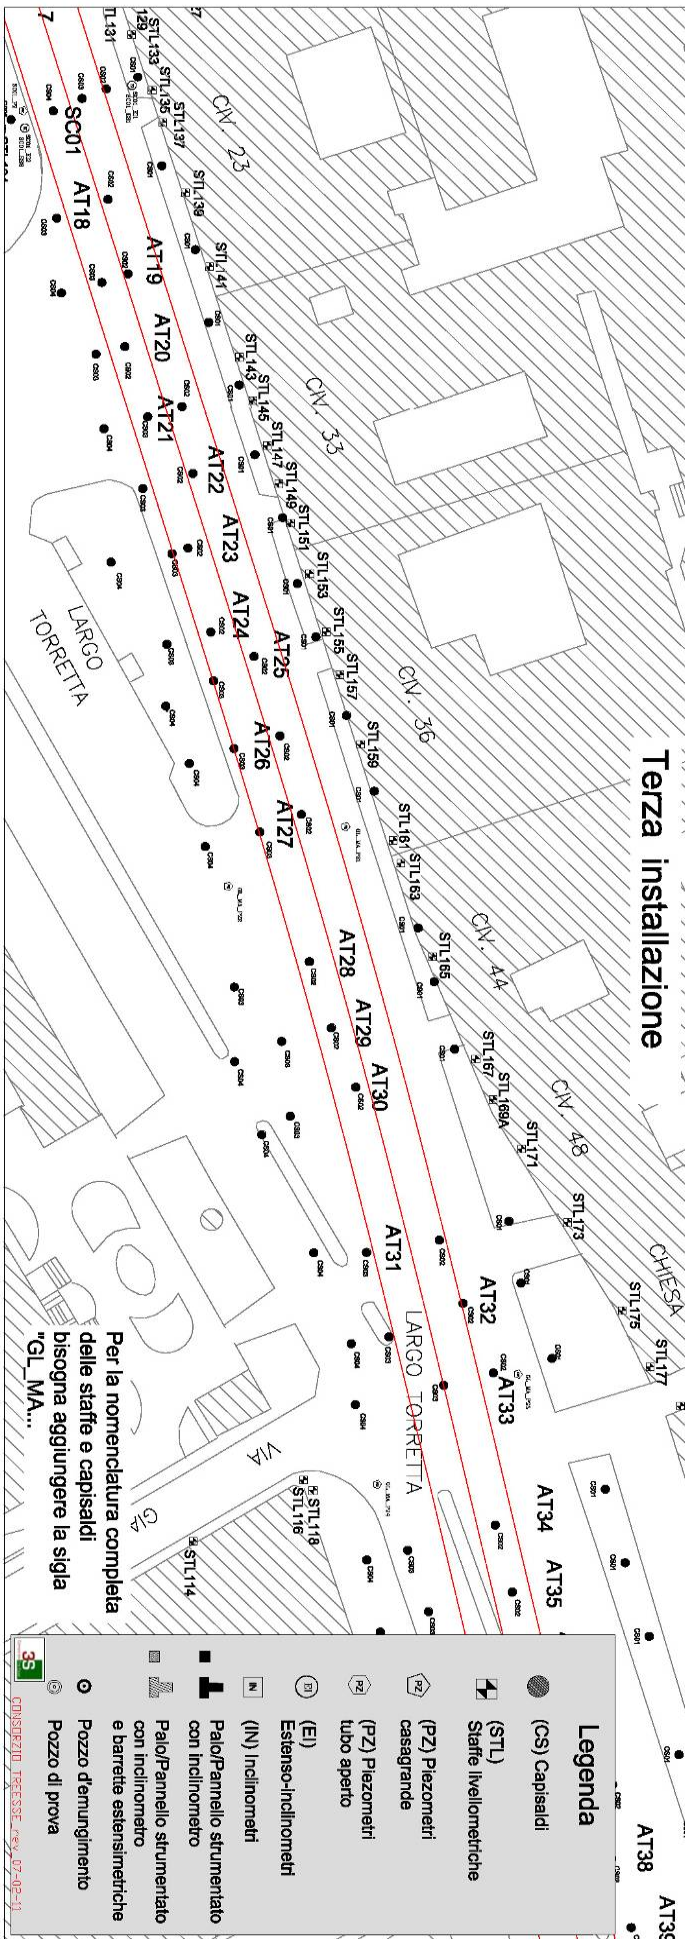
Planimetria tratta Mergellina - Arco Mirelli, raffigurante la disposizione della terza installazione della strumentazione di monitoraggio.
